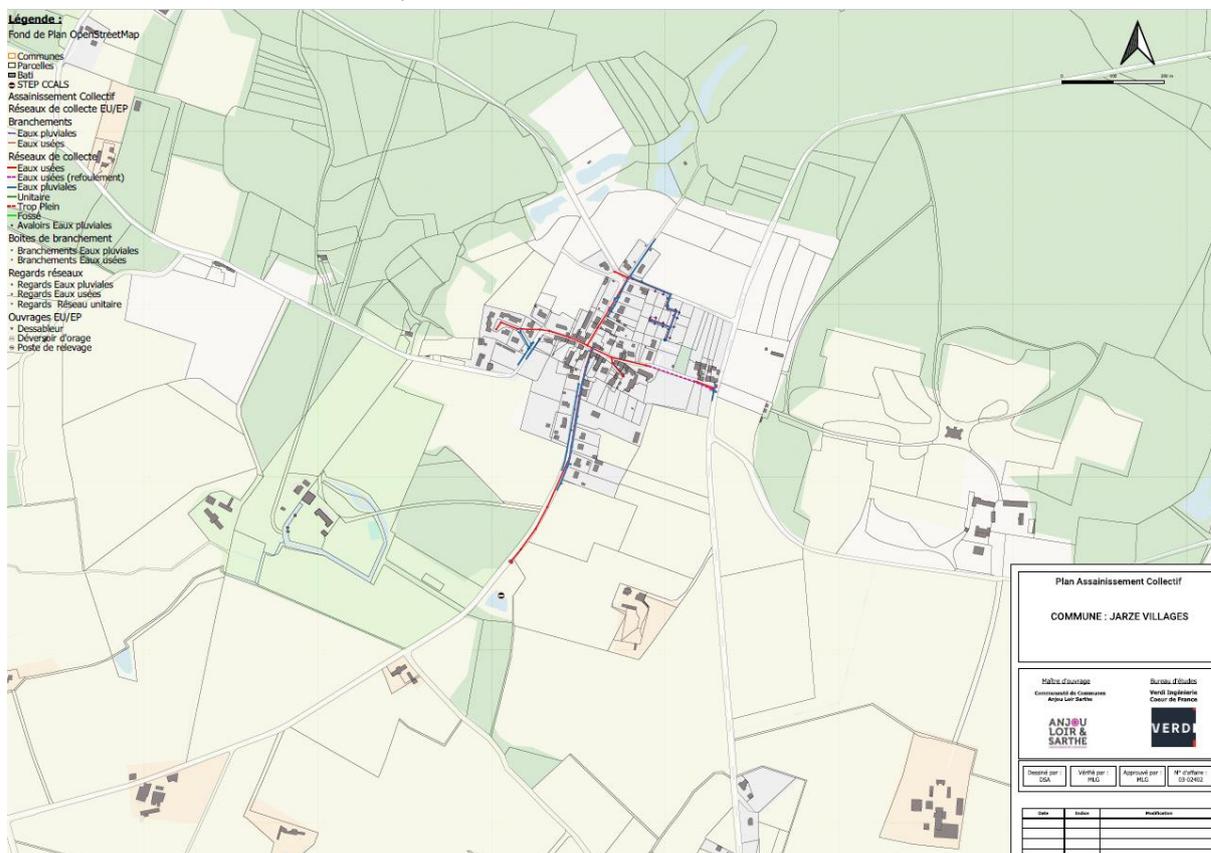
Plan de fonctionnement du réseau d'assainissement du secteur Chaumont-d'Anjou
